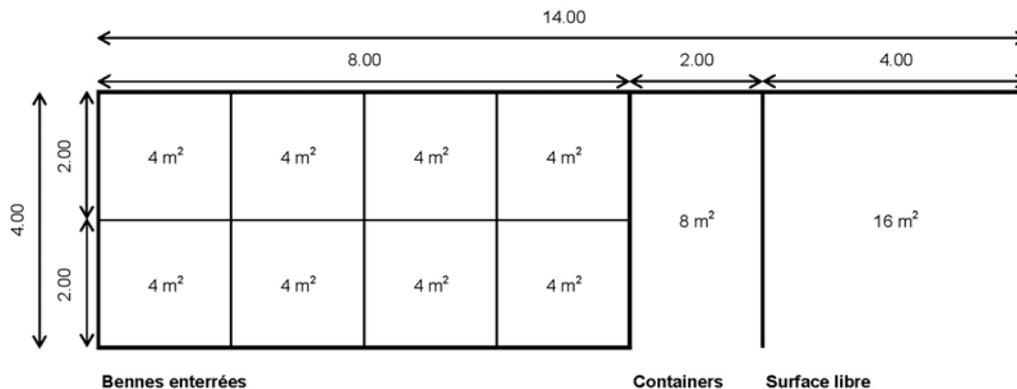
PLAN TYPE D'UN POINT DE RECUPERATION AVEC 8 TERRIERS (SOURCE : VILLE DE VERNIER)
